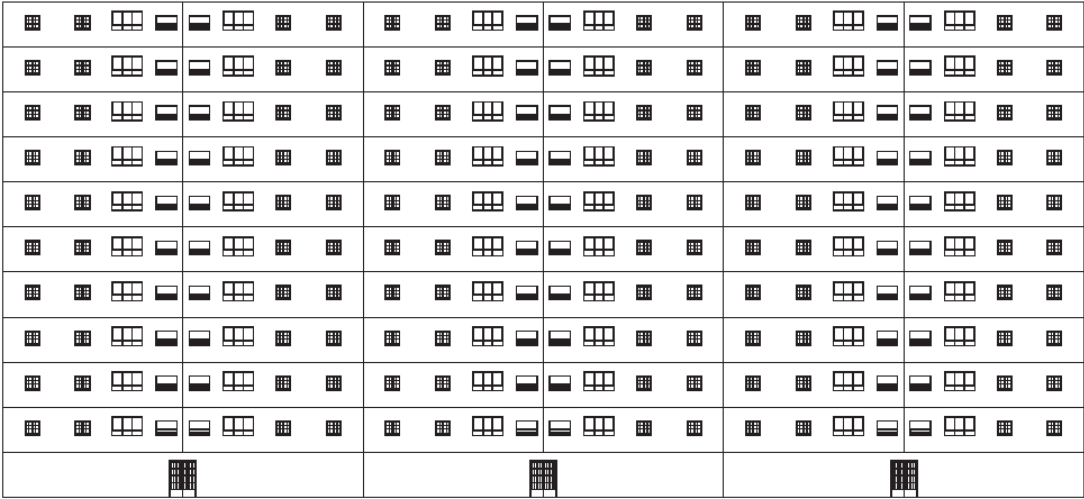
Bloque de viviendas tipo. Elaboración propia
